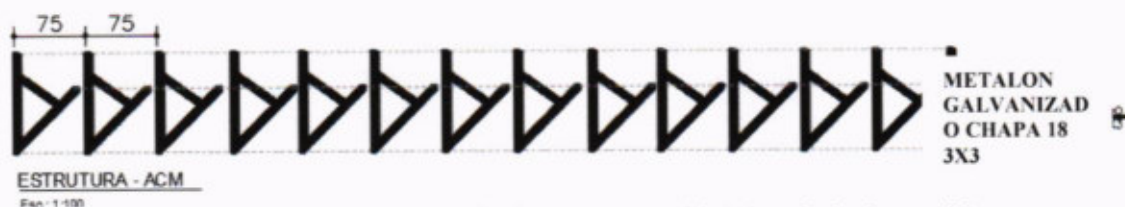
Detalhamento da estrutura. Metalon 3x3 chapa 18.
